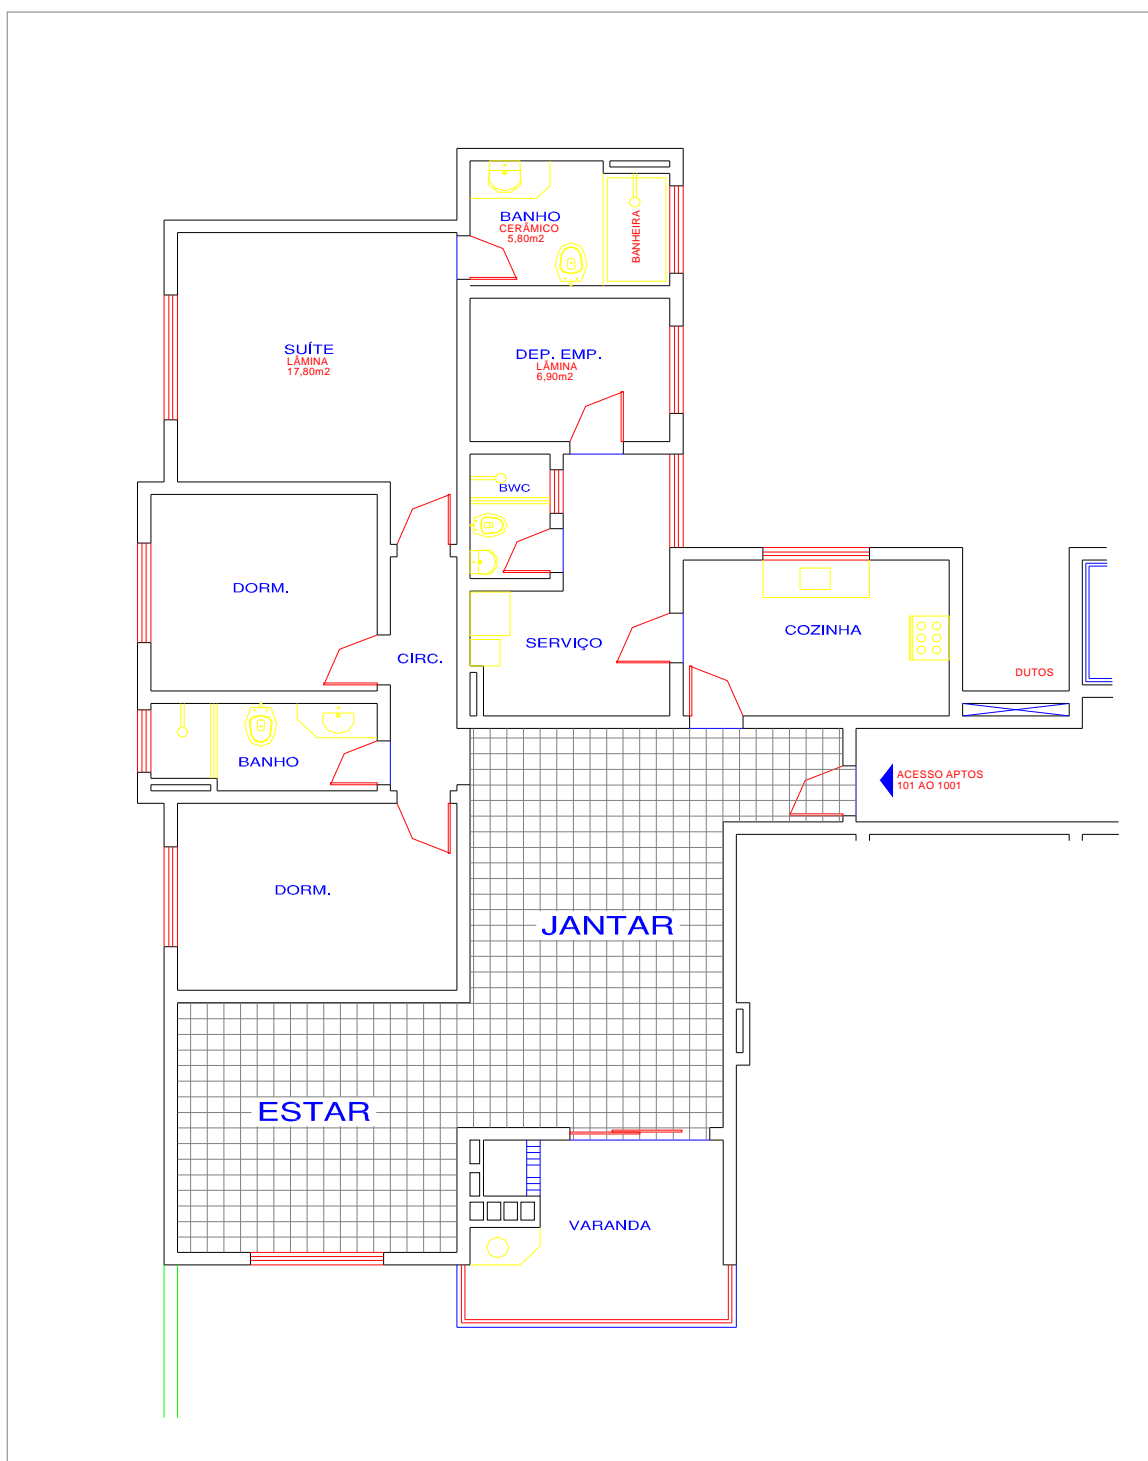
Planta baixa dos apartamentos 101 a 1001.
